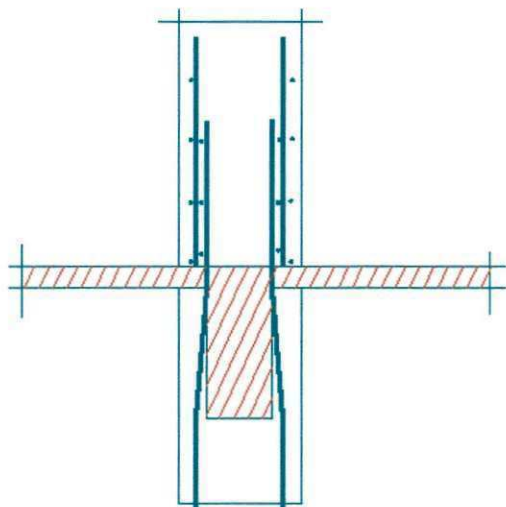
ferro de espera dos pilares dobrados para o interior da continuidade do pilar.
